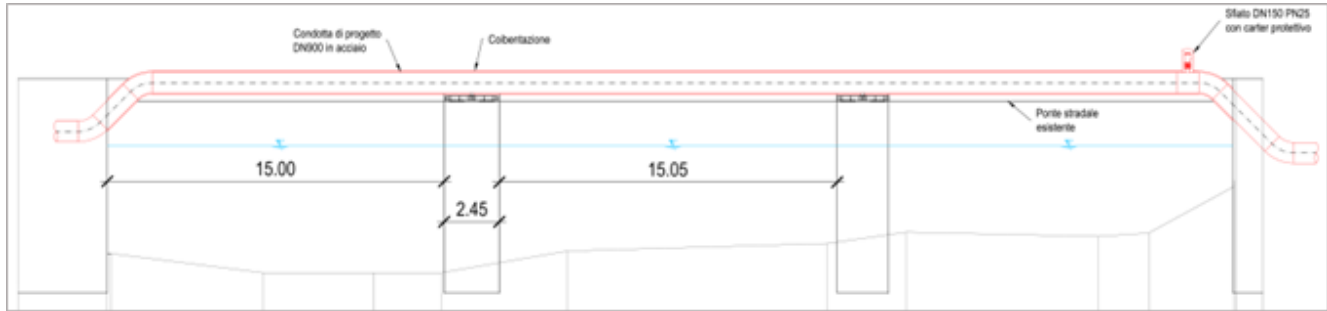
Sezione longitudinale attraversamento aereo di progetto sul fiume Aventino.
